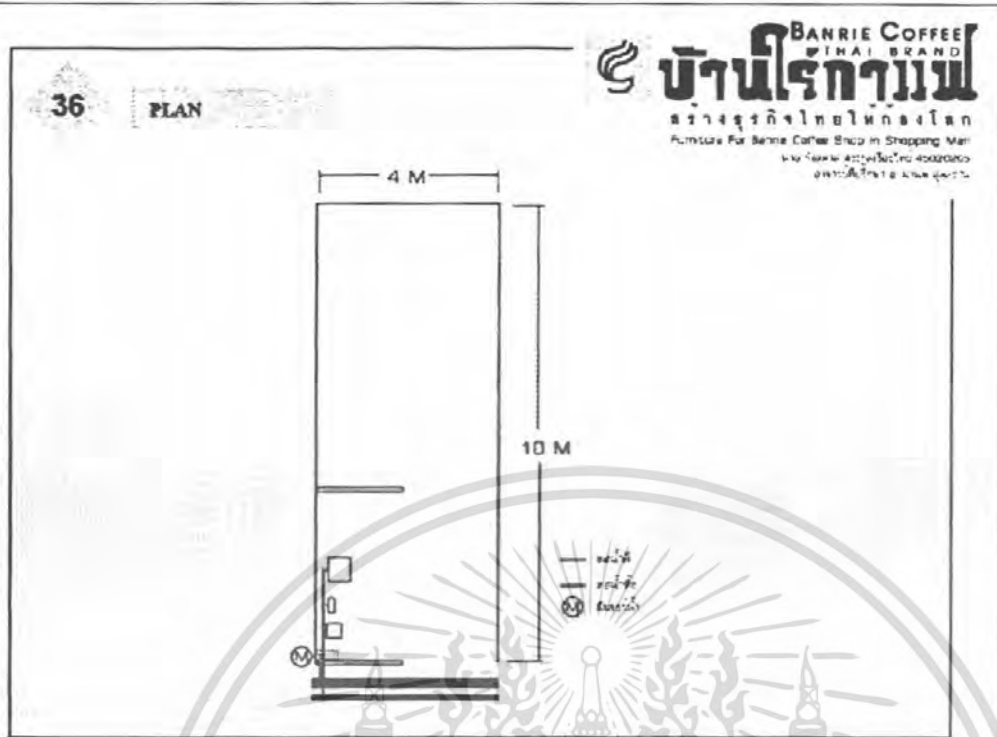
ภาพการนำเสนอข้อมูลการจัดวาง Plan
